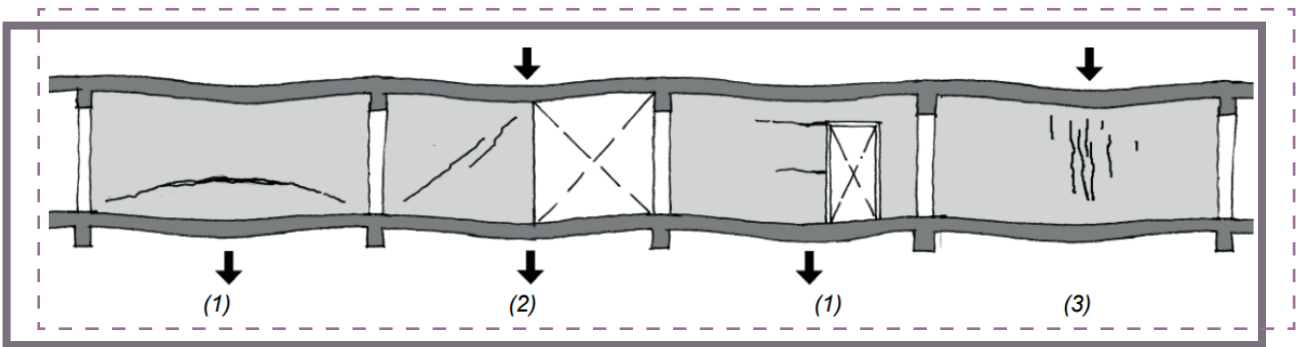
Esquema de las fisuras en muro de hormigón armado por deformación de forjados.
